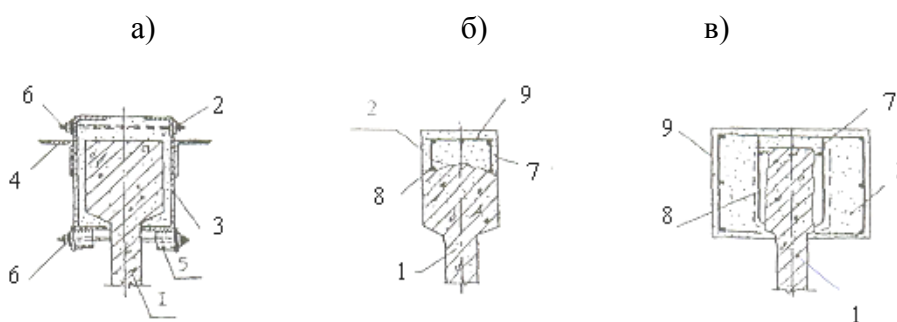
Усиление сборных балок покрытия наращиванием сверху: а – обоймой из швеллеров; б – односторонним наращиванием сверху; в – железобетонной рубашкой; 1 – усиливаемая балка; 2 – плита перекрытия; 3 – швеллеры; 4 – уголки усиления; 5 – упоры для стяжных болтов; 6 – стяжные болты; 7 – соединительные элементы на сварке; 8 – арматура балки; 9 – дополнительная арматура
